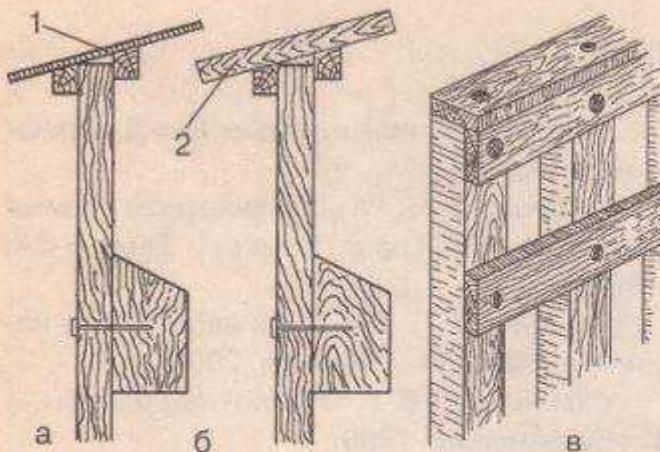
Защита штакетника: а — козырьком из металла; б — козырьком из дерева; в — горизонтальными планками; 1 — металл; 2 — доска
